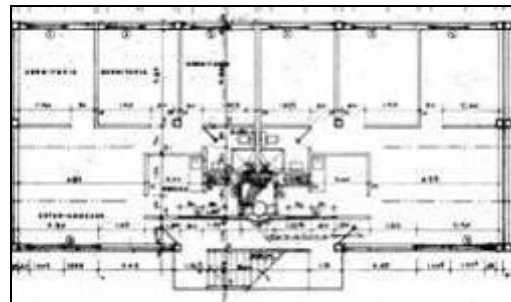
g. Bloque Obrero (escalera longitudinal externa). Planta
